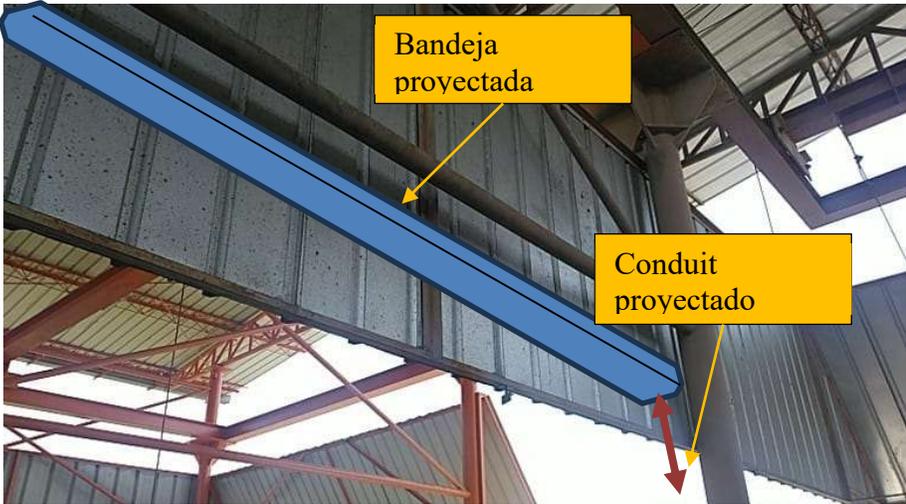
Ubicación de bandeja proyectada de 20cm de ancho.
